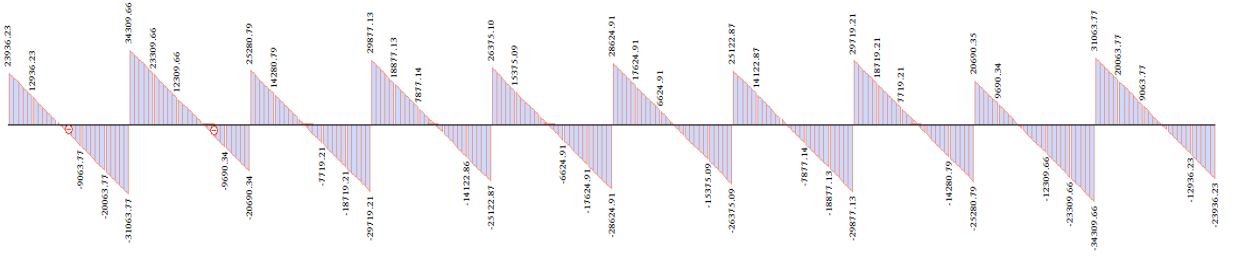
Епюри поперечних сил у поздовжній балці від ваги мостового полотна та власної ваги, Н
